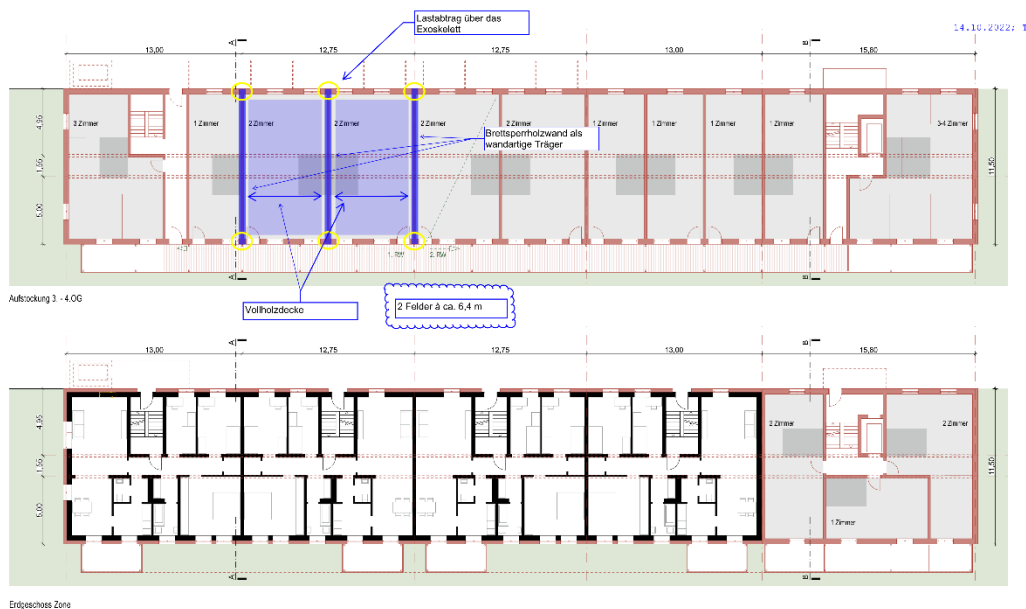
Lastabtrag bzw. das Konstruktionsprinzip der Vertikallasten, Sailer Stepan Tragwerksteam
